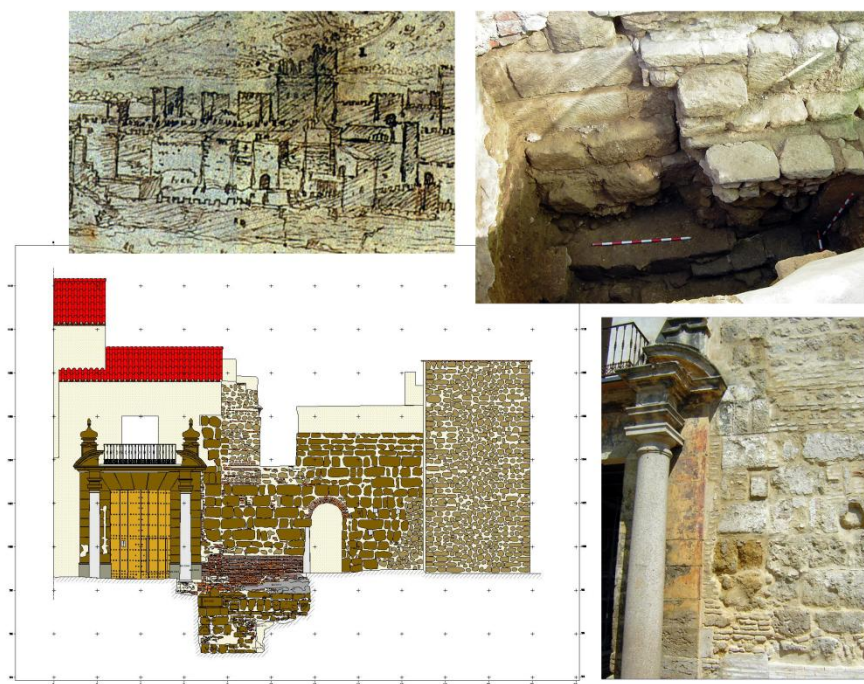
Restos de la portada almohade. Alzado de la portada actual; detalle del dibujo de Wyngaerde; y estructuras de sillería excavadas al pie de la fachada exterior del alcázar
